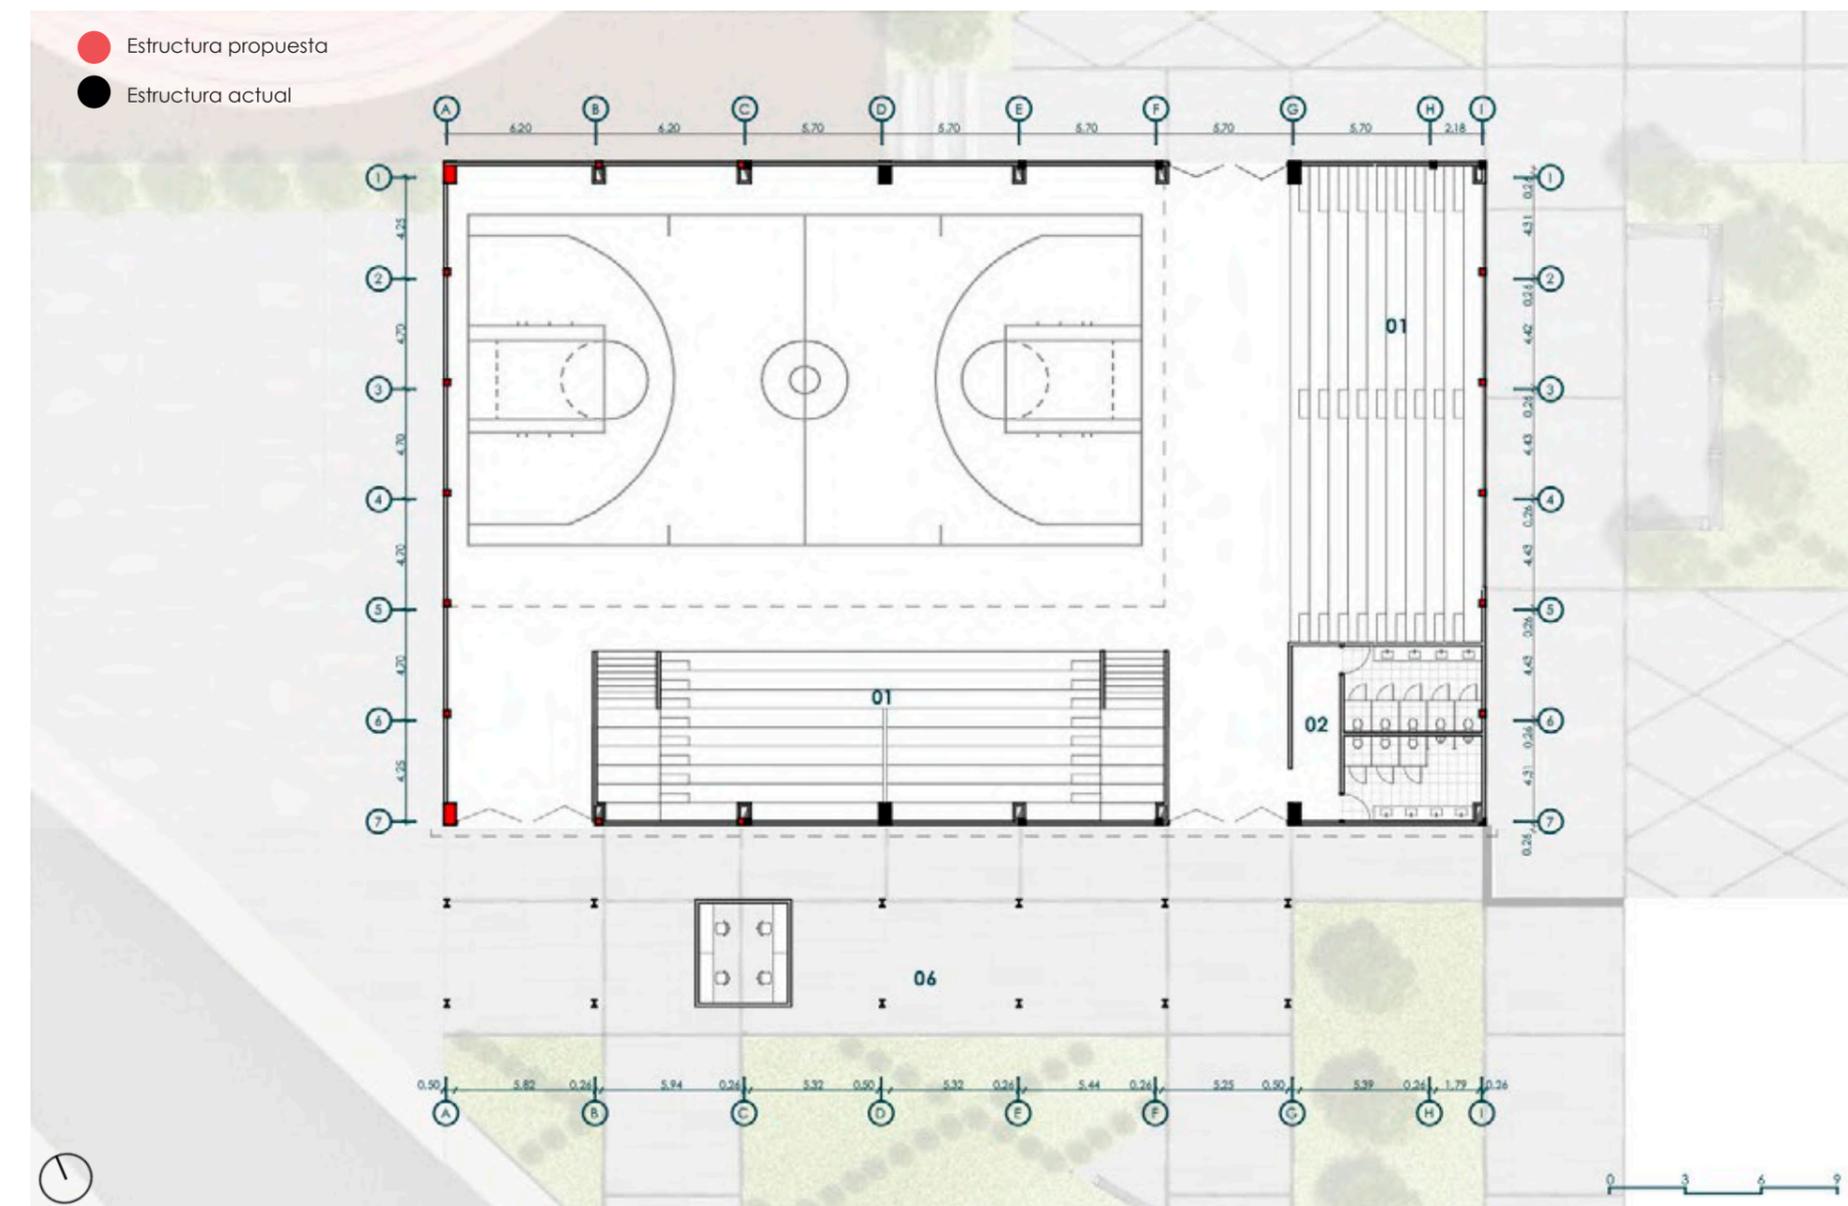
| Planta alta coliseo | Fuente: Elaboración Propia
